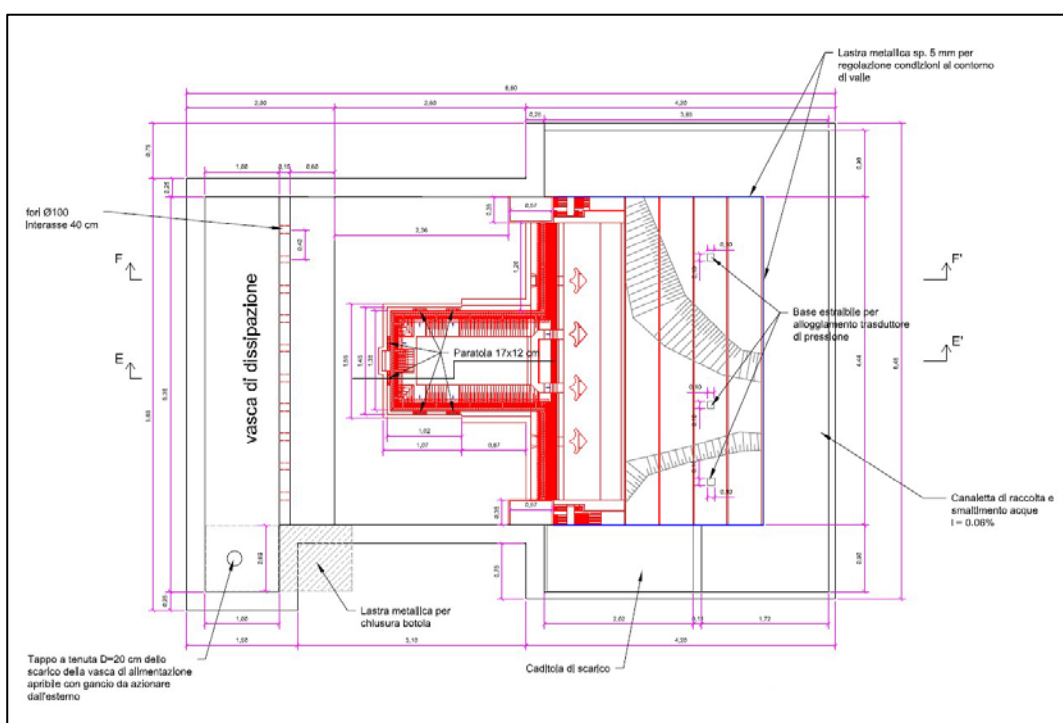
PLANIMETRIA DEL MODELLO FISICO RELATIVO ALLA NUOVA TRAVERSA DI LAMINAZIONE IN LINEA SUL FIUME SECCHIA
